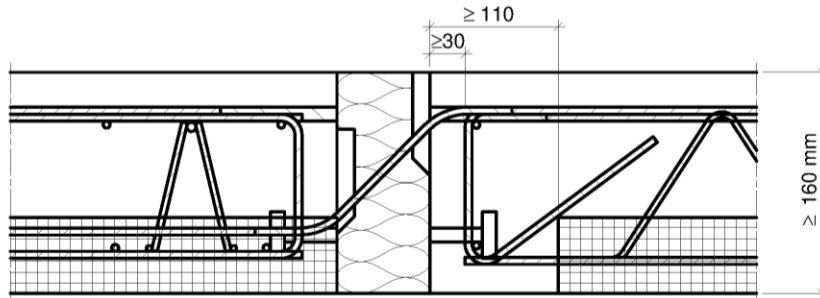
Beispiel Schöck Isokorb® Typ K bzw. KF mit Elementplatten
